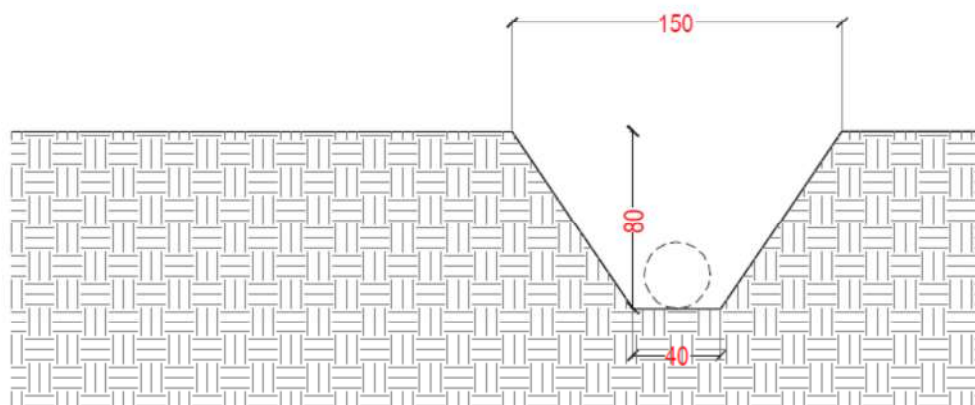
Sezione del fosso che attraversa la proprietà con asse N-S
